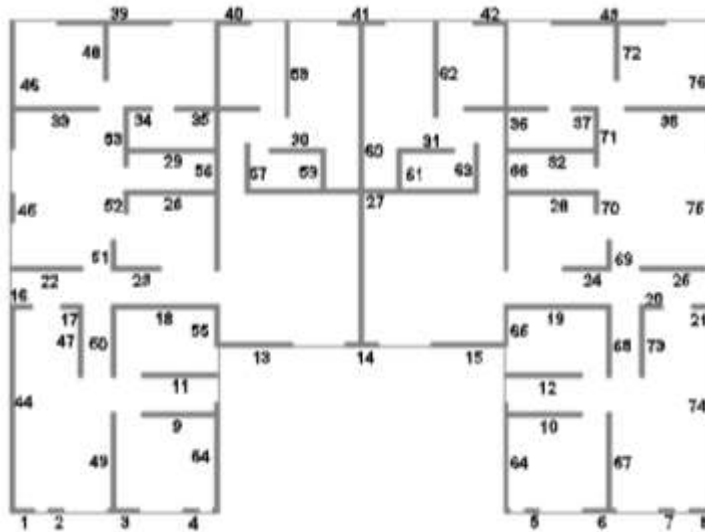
Planta estructural Agrícola Oriental con numeración de muros
